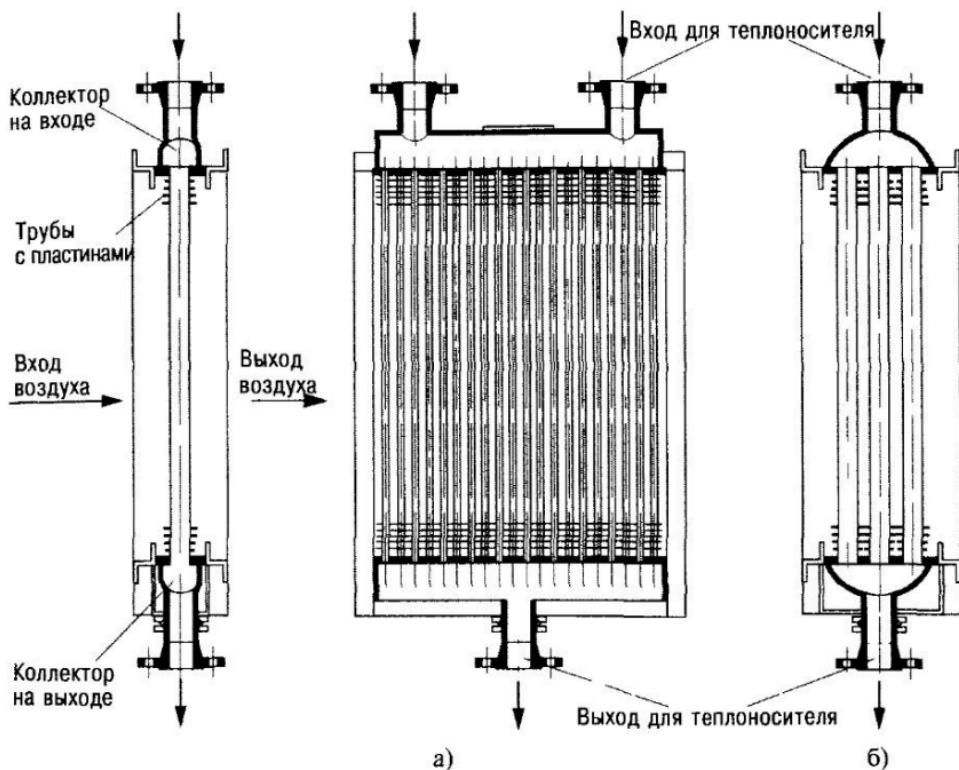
Воздухонагреватель из пластинчатых труб, для пара [1]: а – с одним рядом труб; б – с тремя рядами труб.
